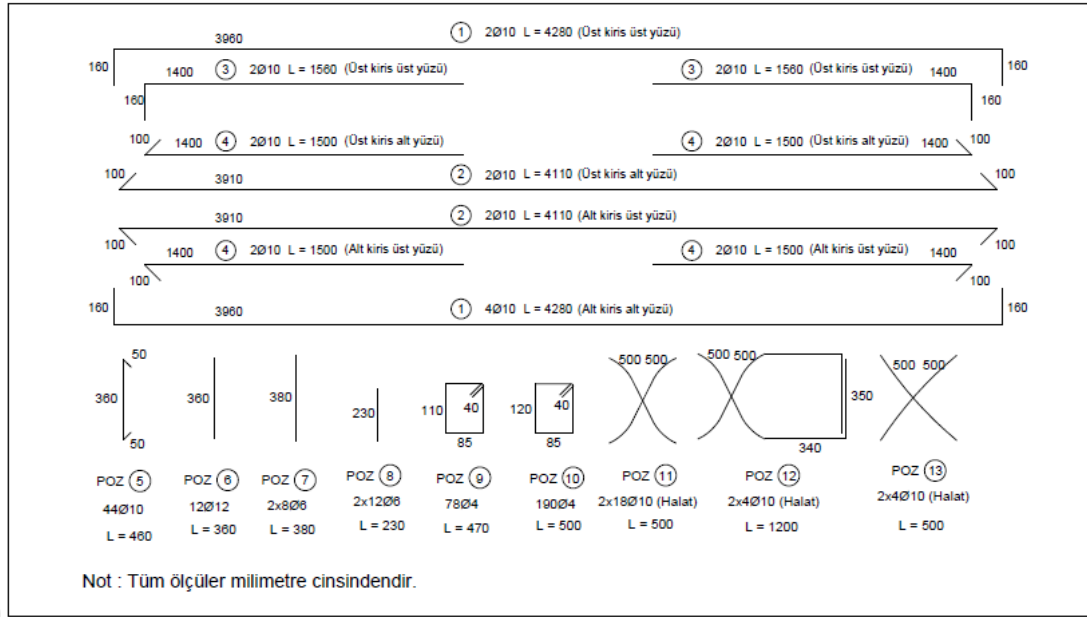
RRxn Kirişi kiriş donatı Planı ve Kesitleri
